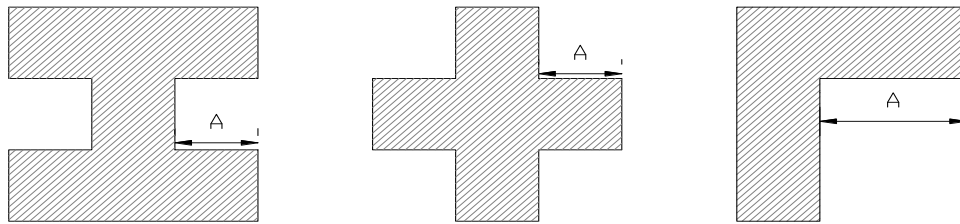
Plantas con alas(A) muy largas (Bazán et al., 2008).
